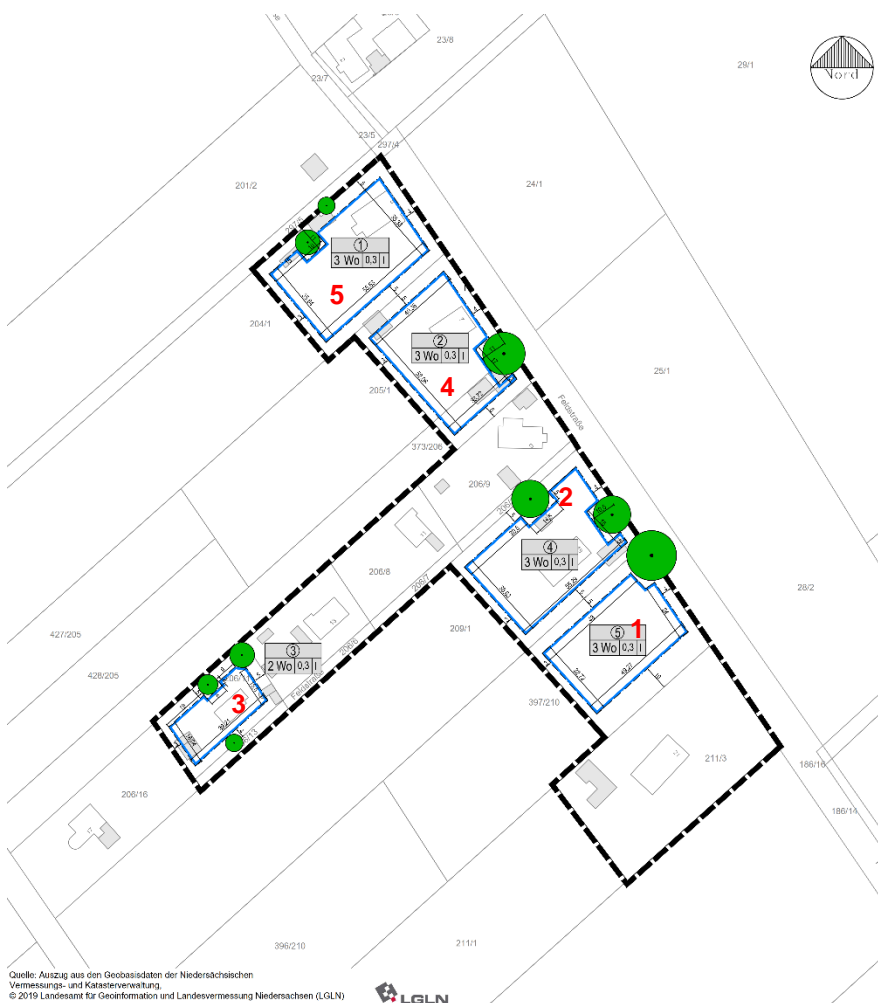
Ausschnitt aus der Planzeichnung mit Nummerierung der betroffenen Grundstücke 1 bis 5 und Darstellung der geplanten Bereiche für Um- und Neubauten.
